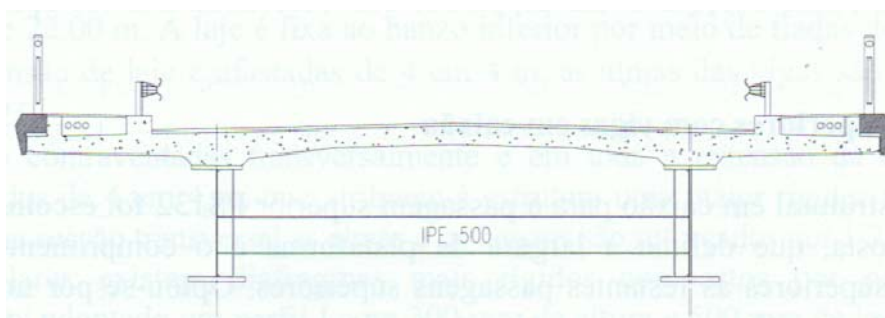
Secção transversal tipo da solução "bi viga"[R7]
